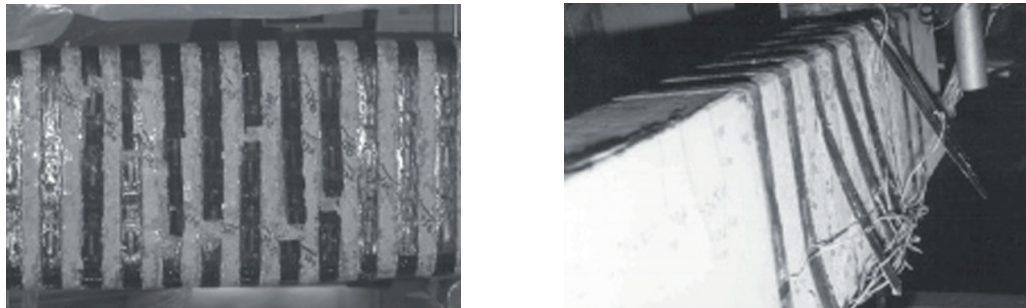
Colapso de vigas por ruptura e por descolamento do PRFC.
